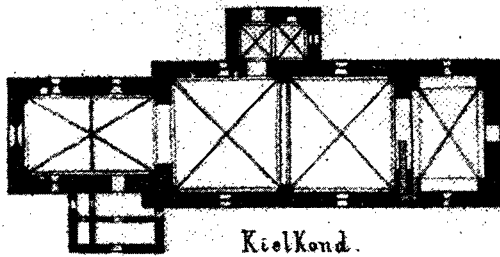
Grundriss der Kirche zu Kihelkonna.
